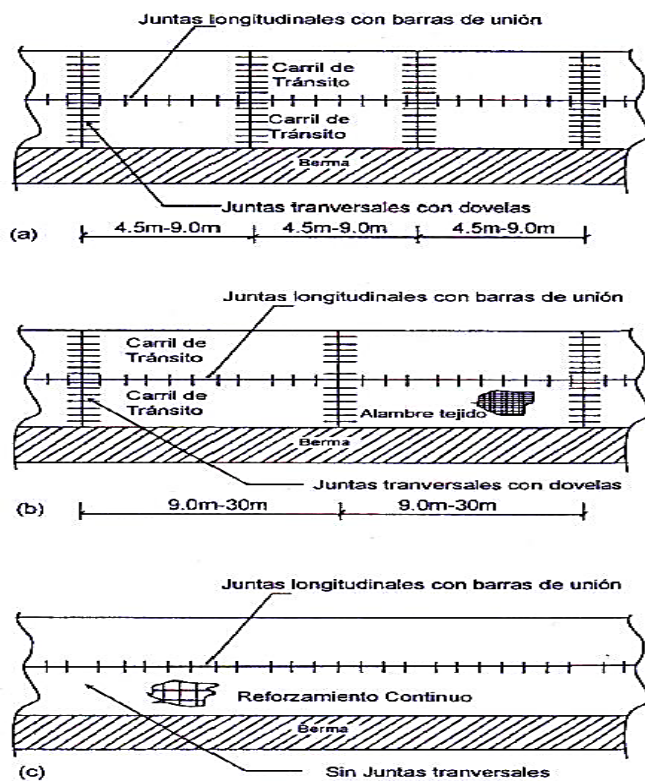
Tipos de pavimentos de concreto, JPCP, JRCP, CRCP (2008)
